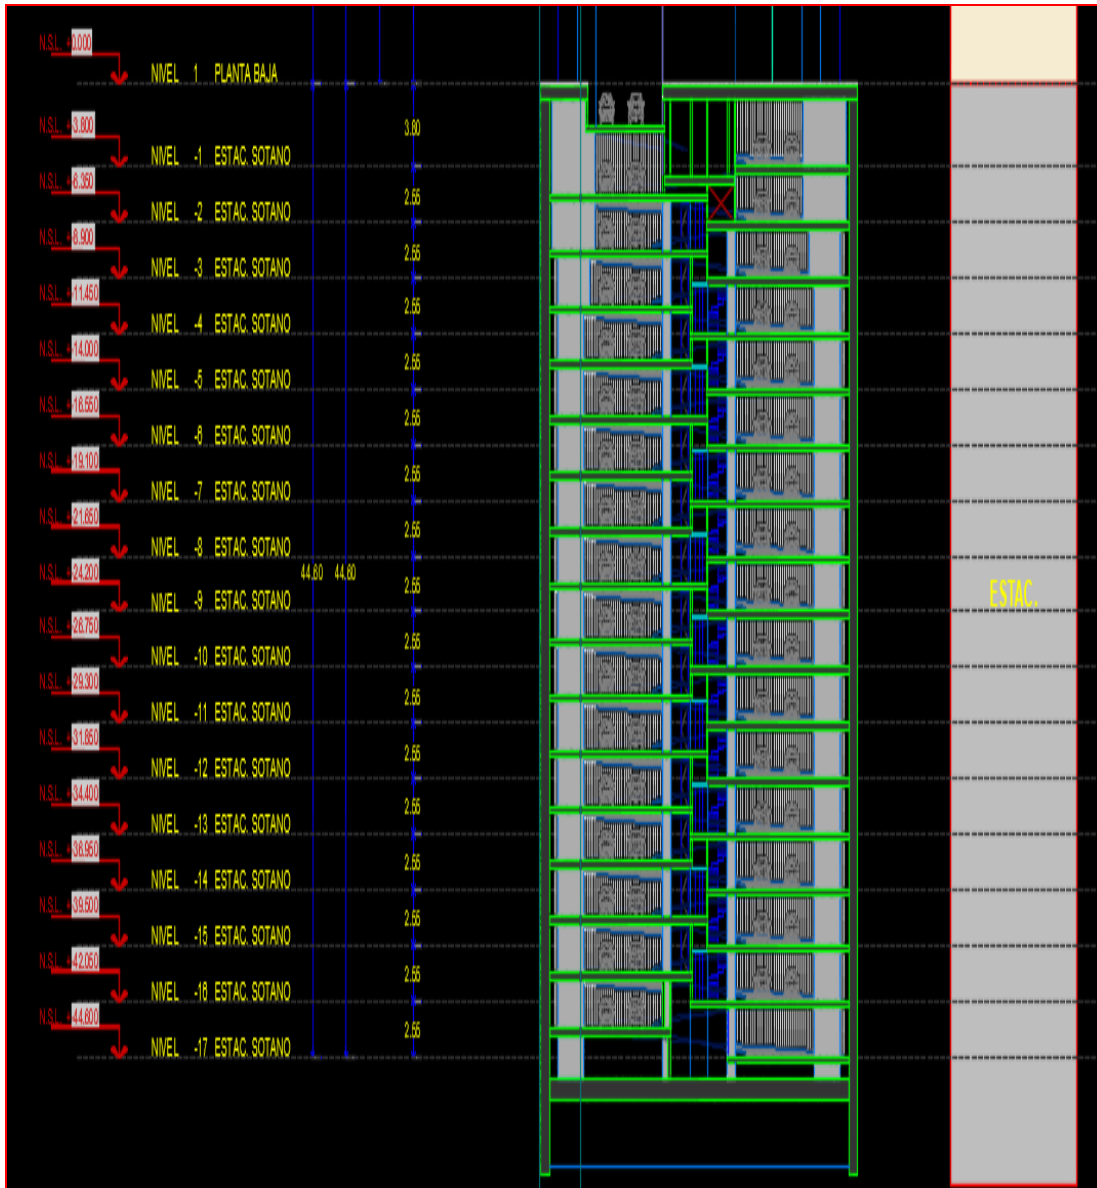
Plano Arquitectónico de sótanos del proyecto inmobiliario. (CIMESA 2018).
